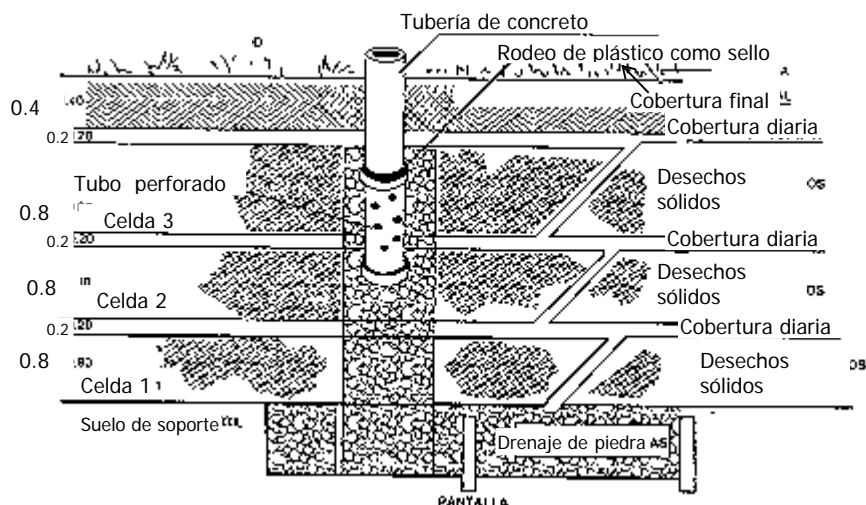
Detalle constructivo del filtro para drenaje de gases.
